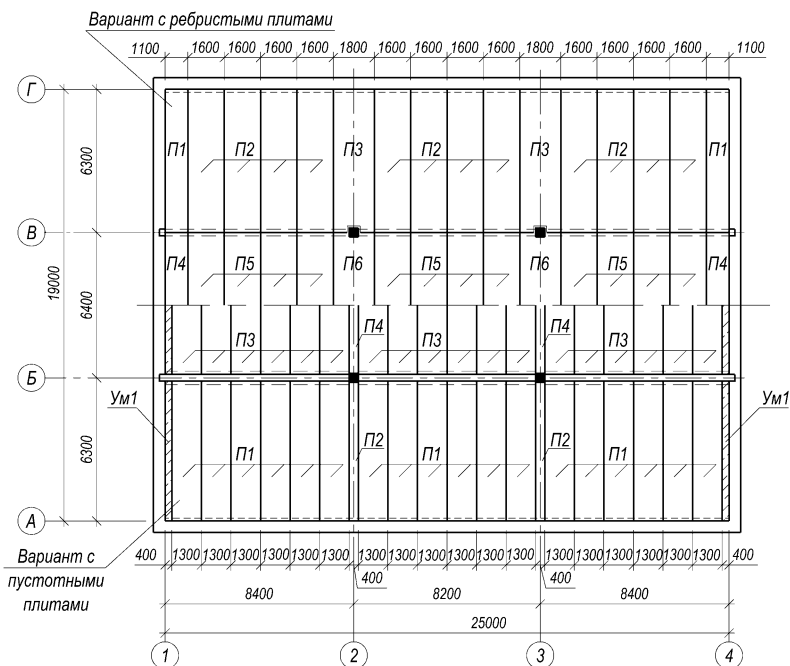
Схема перекрытия с продольным расположением ригелей
